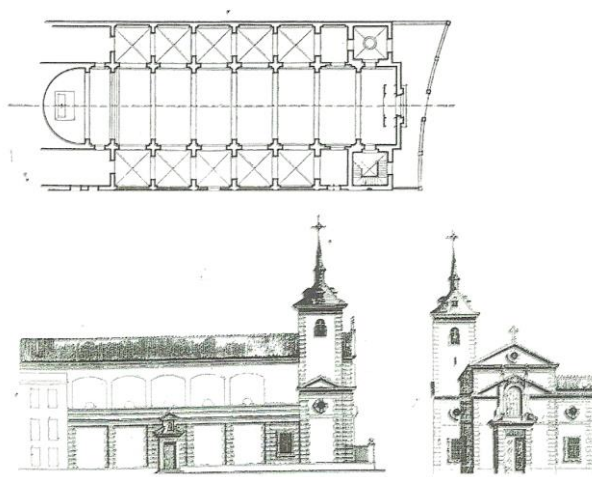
Planta, alzada y sección de la aplicación del Arquitecto Manuel Ruiz de Prada, como se puede ver mantenía un atrio más pequeño por delante de la puerta de los pies.
